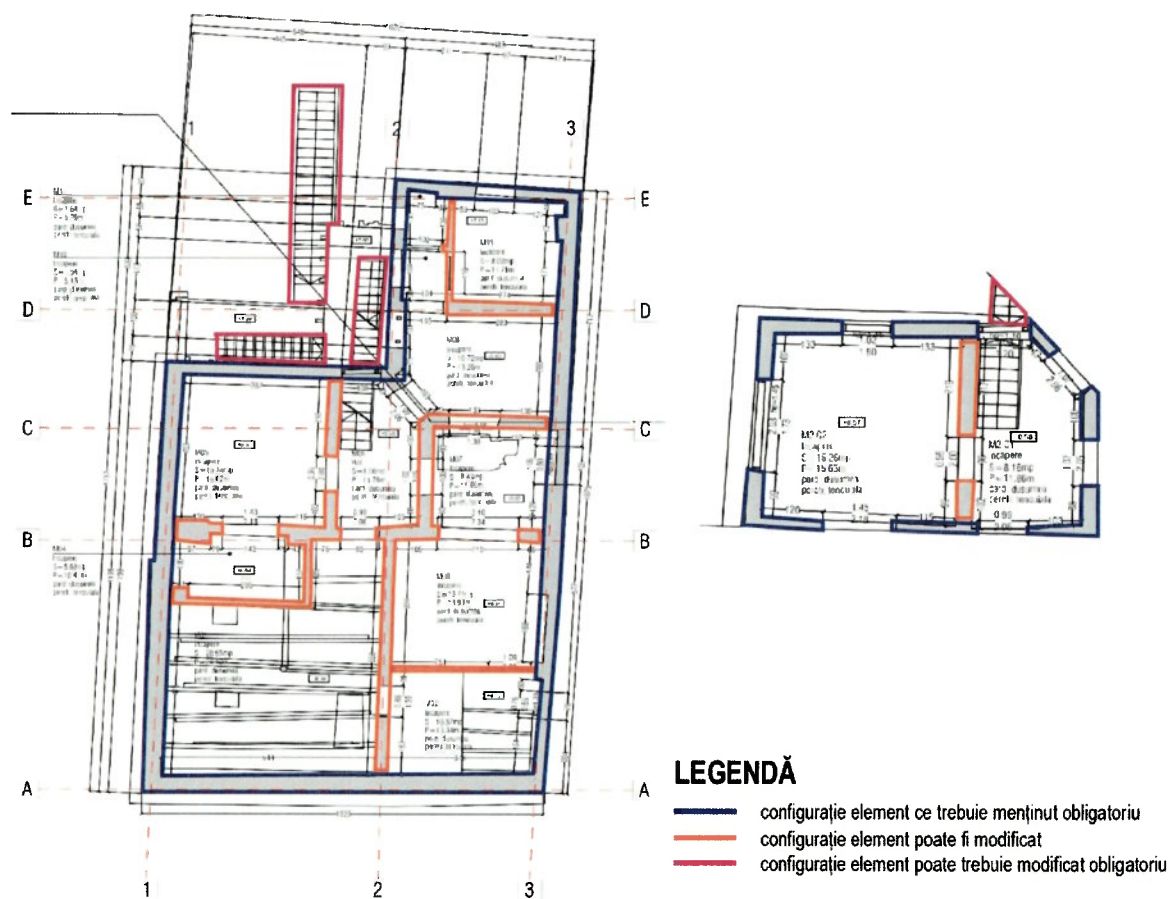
Plan mansardă – atitudini față de elementele construcției
